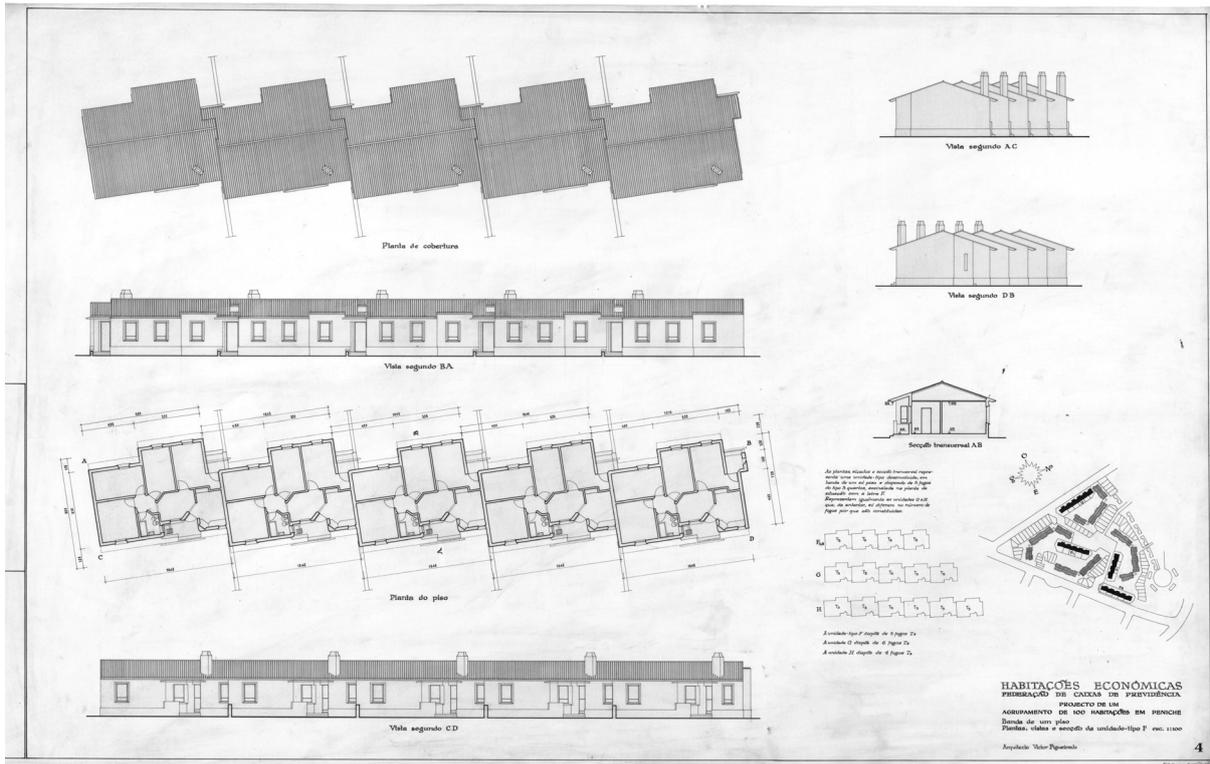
Projeto: banda de um piso, plantas, vistas e secção da unidade tipo F
